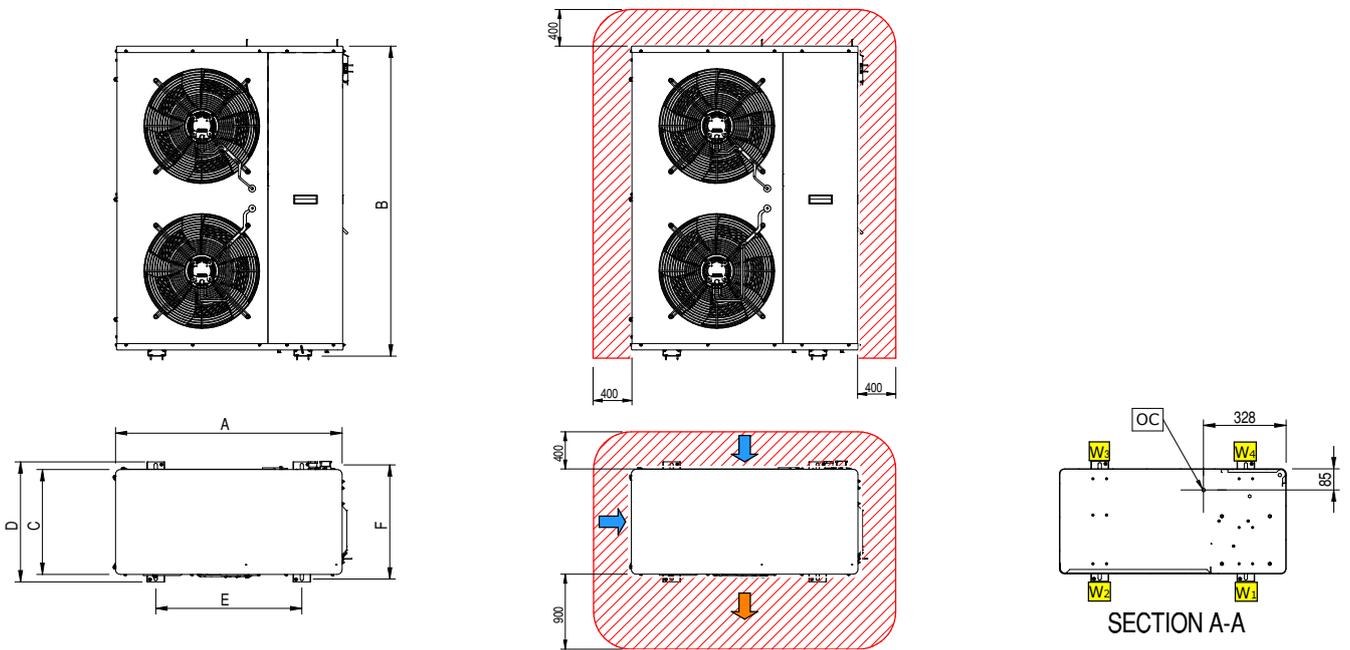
disegno dimensionale taglie 11V, 15V e 15Y
